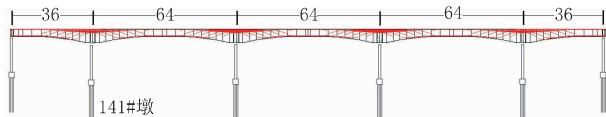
36 m+3×64 m+36 m 连续梁桥立面图(单位:m)
